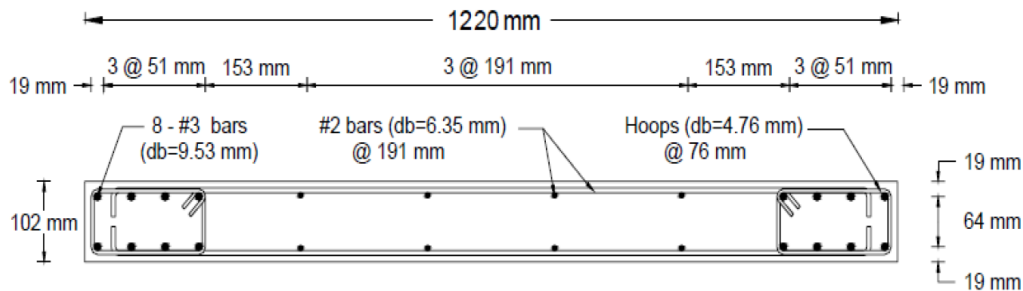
Corte transversal del espécimen de hormigón armado [16]
